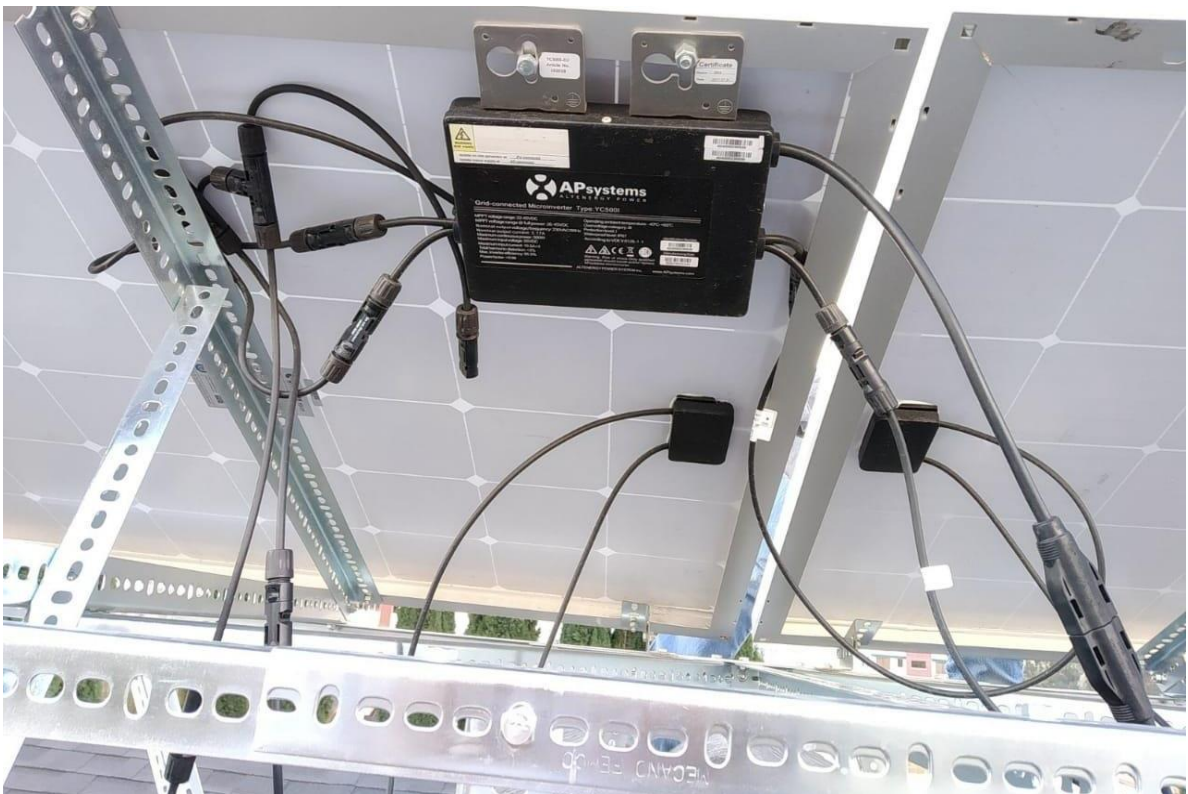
Montaje de la estructura en el techo de la vivienda.
